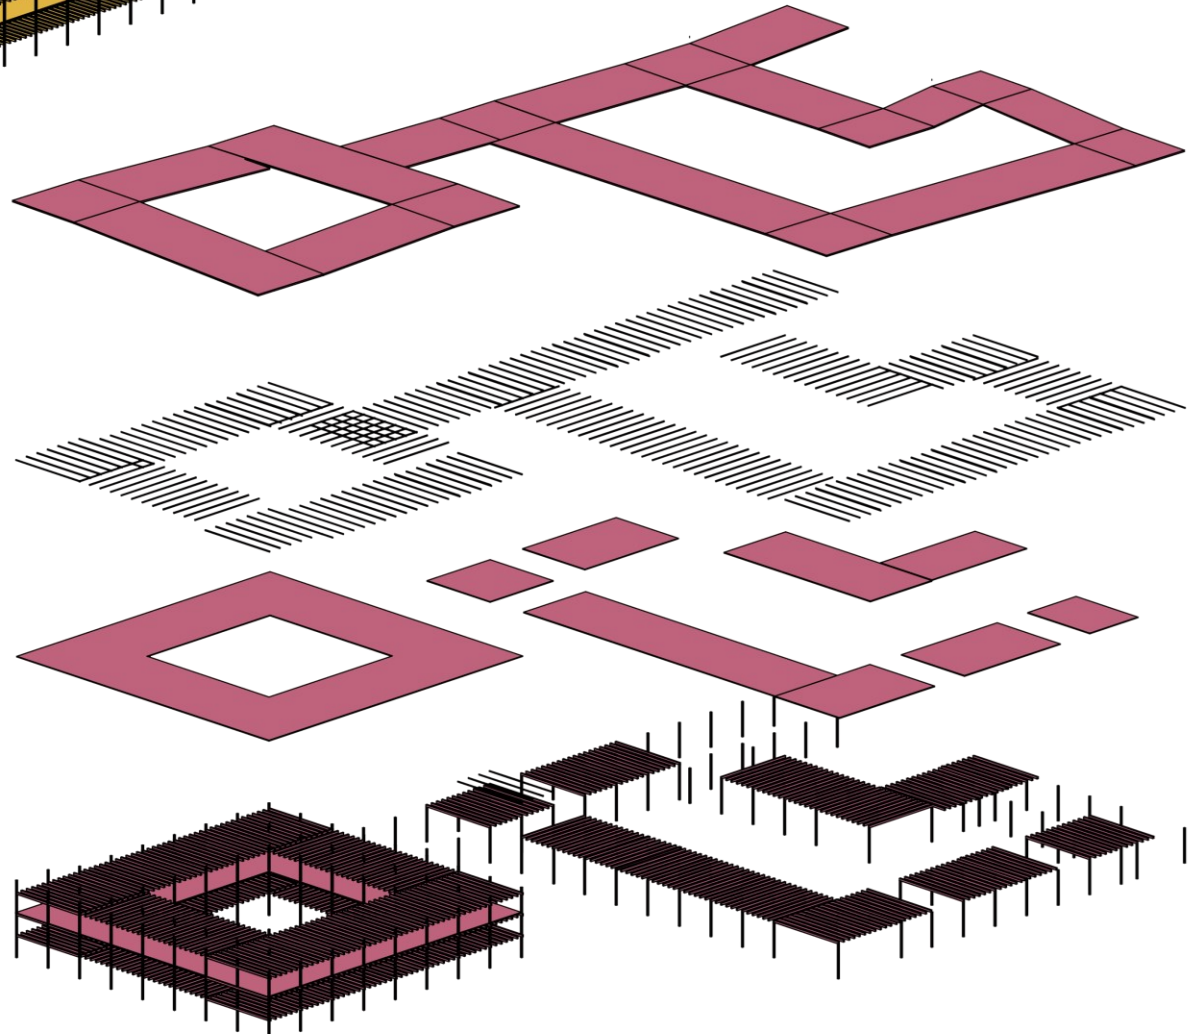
Esquema Estrutural. Fonte: Isadora Benaion
